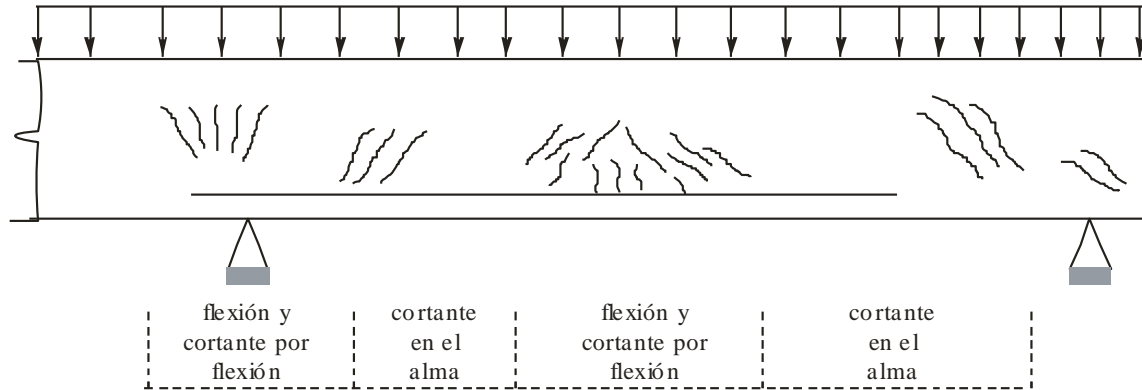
Tipos de agrietamiento en vigas de concreto.
